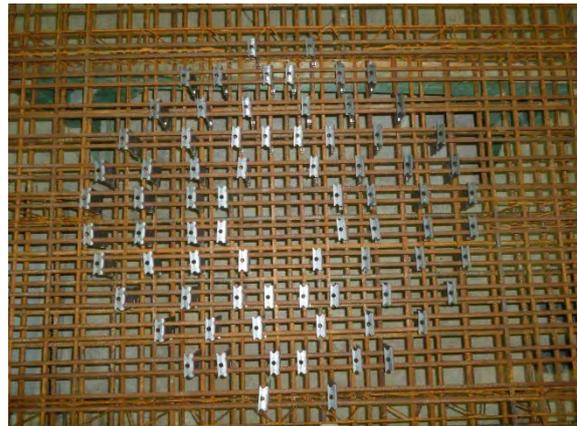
Eingebaute CLIXS-Durchstanzbewehrung: Draufsicht
